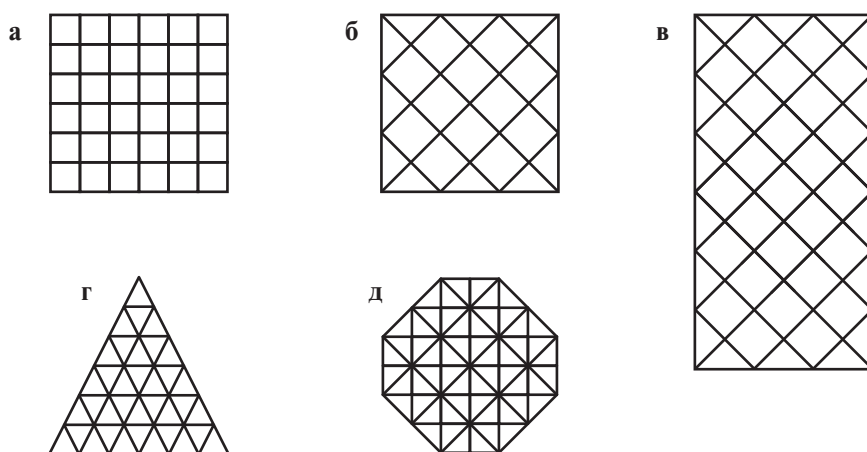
Формы в плане покрытий перекрестных систем: а, б, в) квадратные и прямоугольные; г) равнобедренный треугольник; д) многоугольник, вписанный в круг
